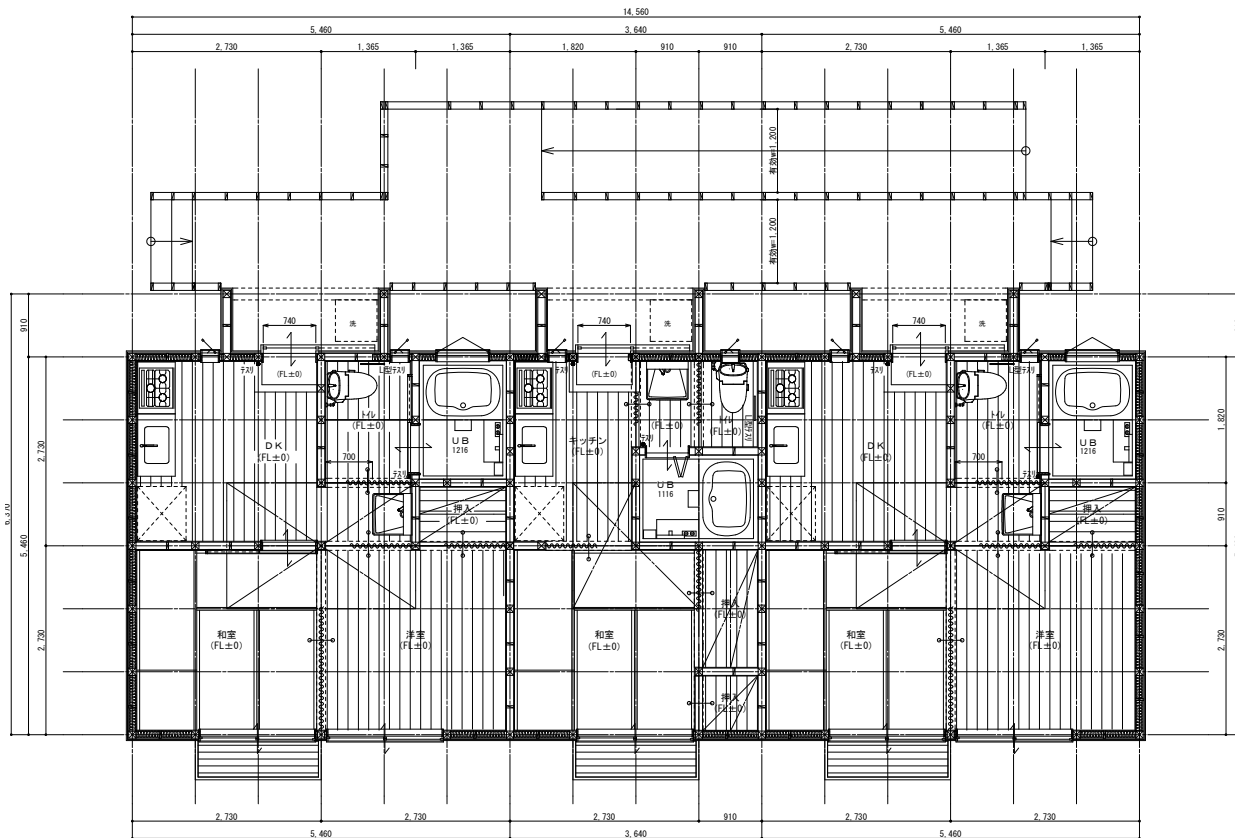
改良型スロープ棟 (木造応急仮設住宅) 平面図
